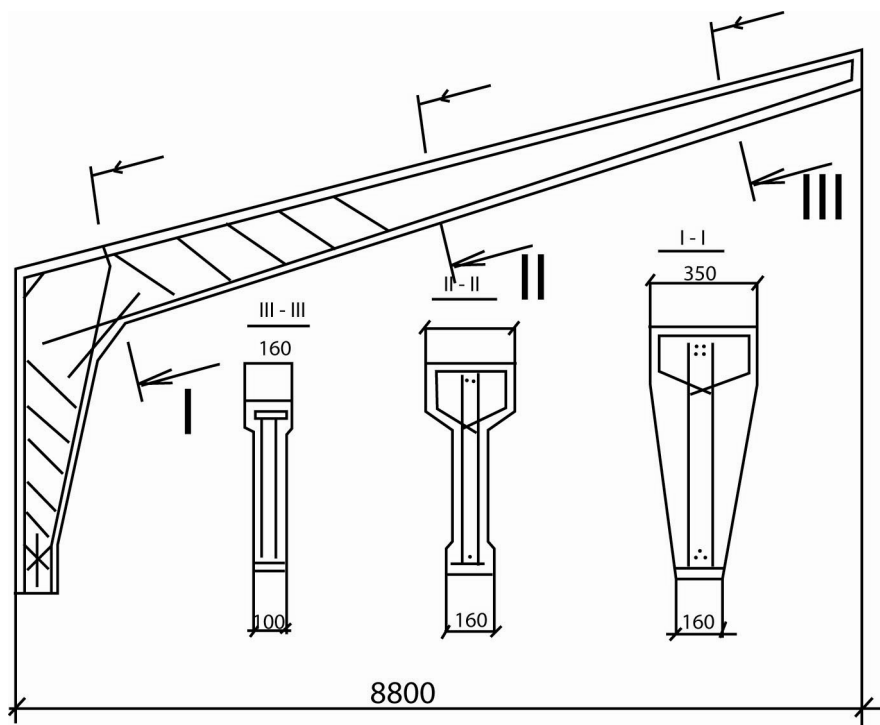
Основні розміри і схема армування піврами, що розроблена фірмою «Джи і Джи» /Італія/
